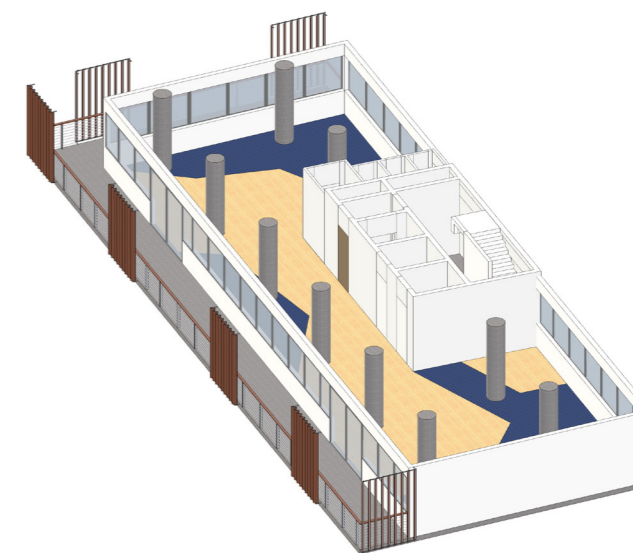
Perspectiva do pavimento tipo da Torre 1.
